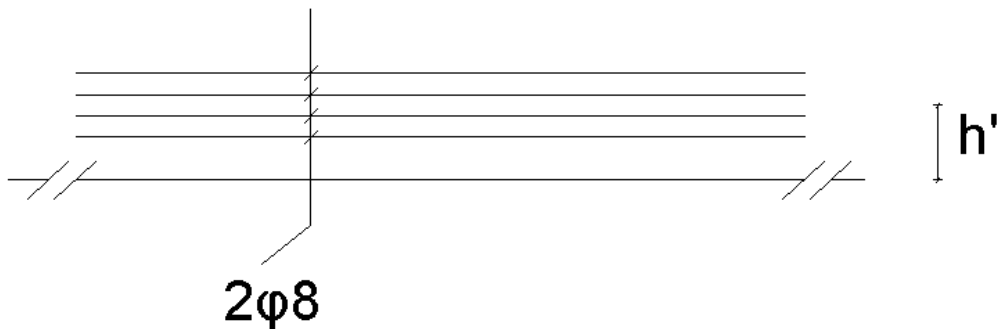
Pormenor do cálculo do centróide das armaduras
